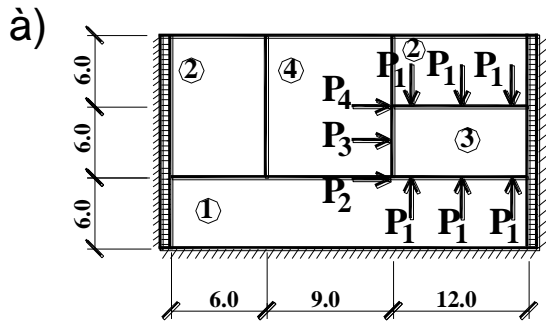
Розрахункові схеми ґрунтової основи будівель.
